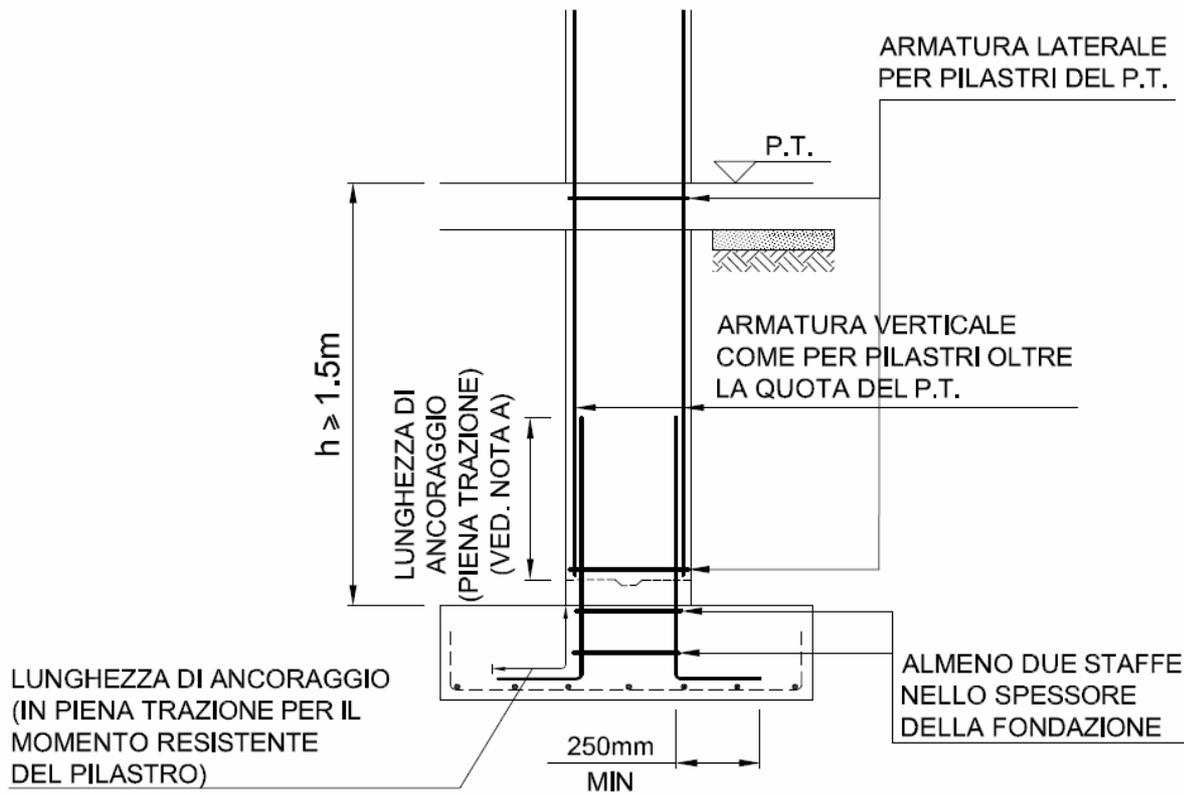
Particolari costruttivi: armatura di ripresa dei pilastri (Nota A: se l'altezza "h" è sufficientemente elevata, nelle zone a medio ed alto rischio sismico il giunto di costruzione pilastro – fondazione deve essere realizzato a metà altezza del pilastro).
